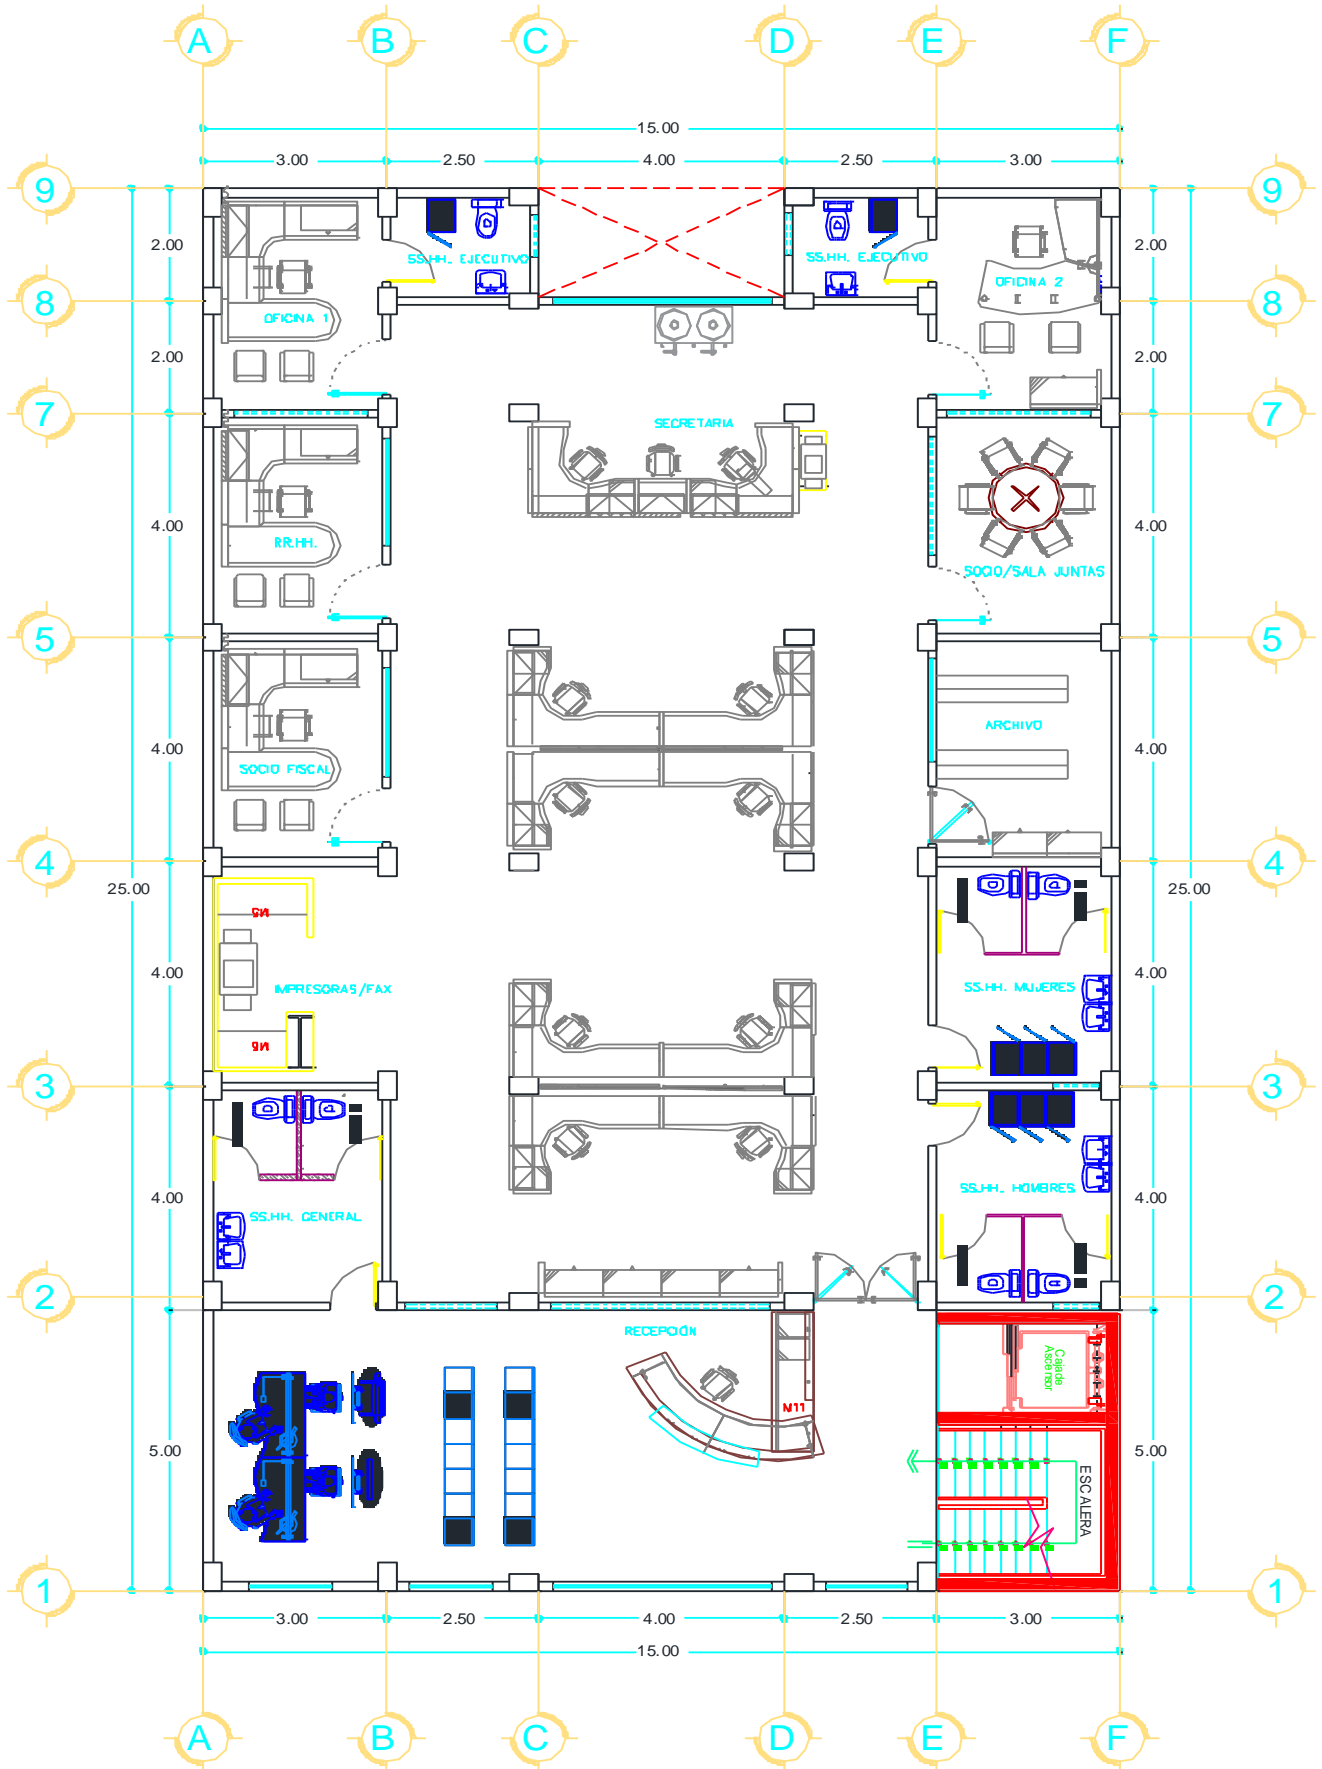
Plano en planta del edificio que va desde el piso dos hasta el piso nueve.
